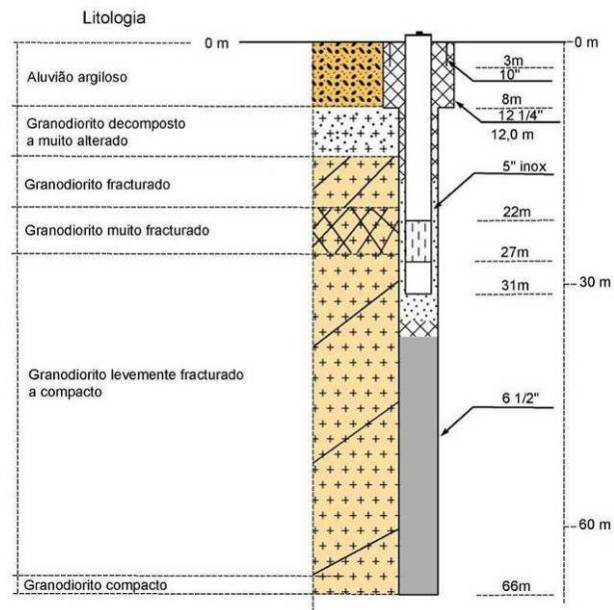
Perfil esquemático do Furo AC1 (adaptado de A.Cavaco, 1990).
